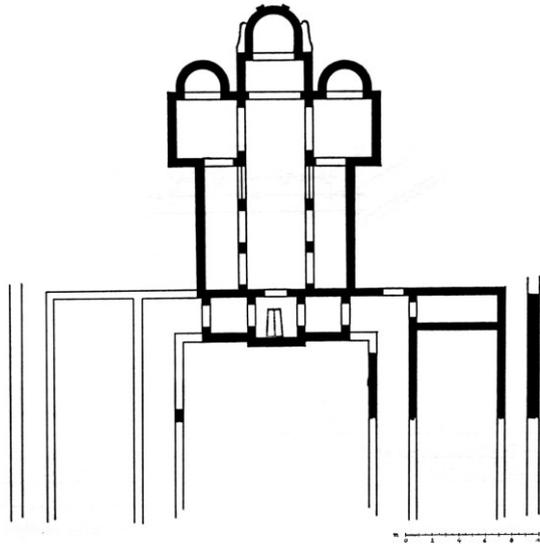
Abteikirche Inda (Kornelimünster): Grundriss nach Leo Hugot (1968)
